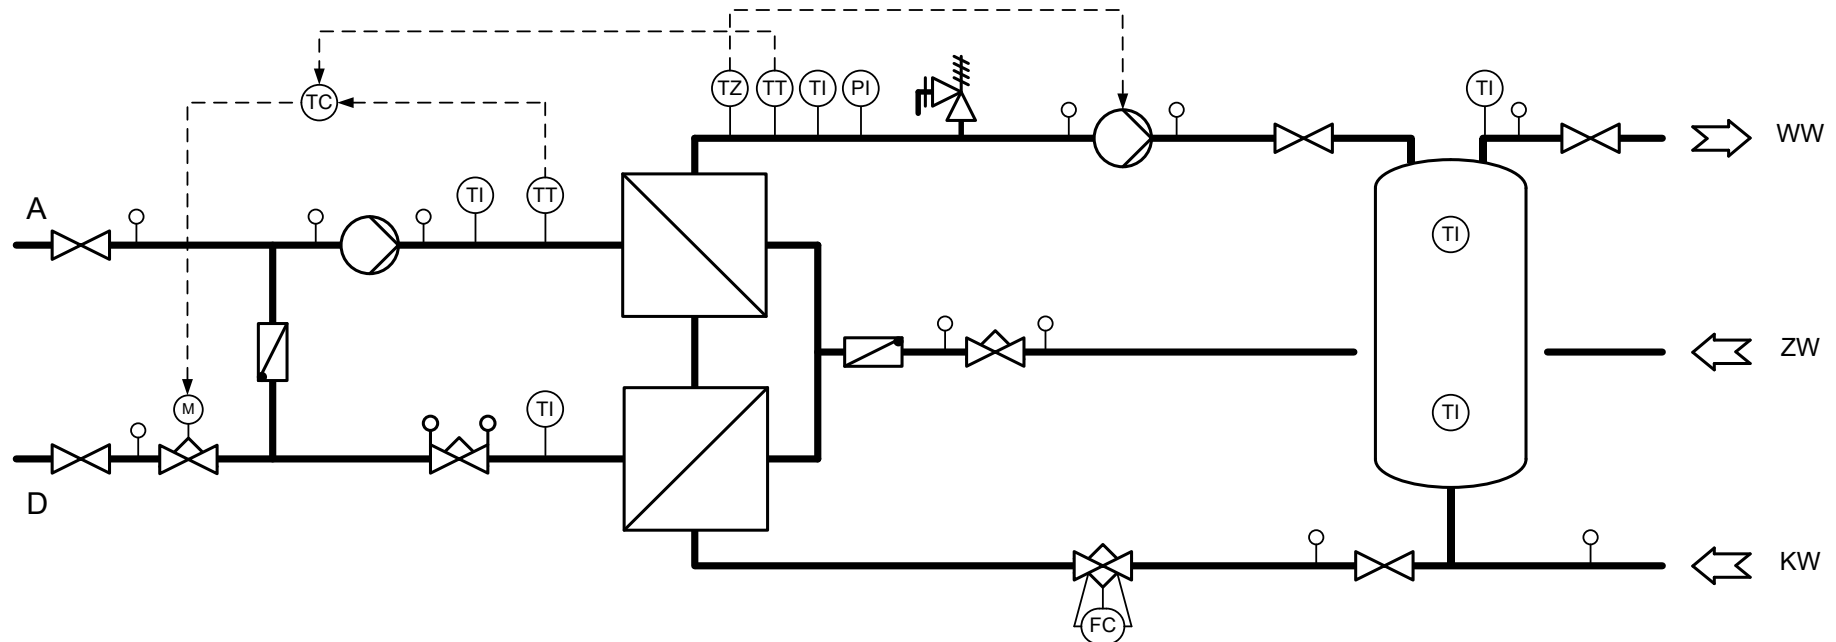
Speicherladesystem mit Einspritzschaltung mittels Motordurchgangsventil
